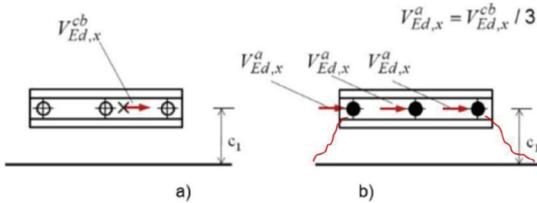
8 - 2 侧面混凝土的边缘破坏示意图
